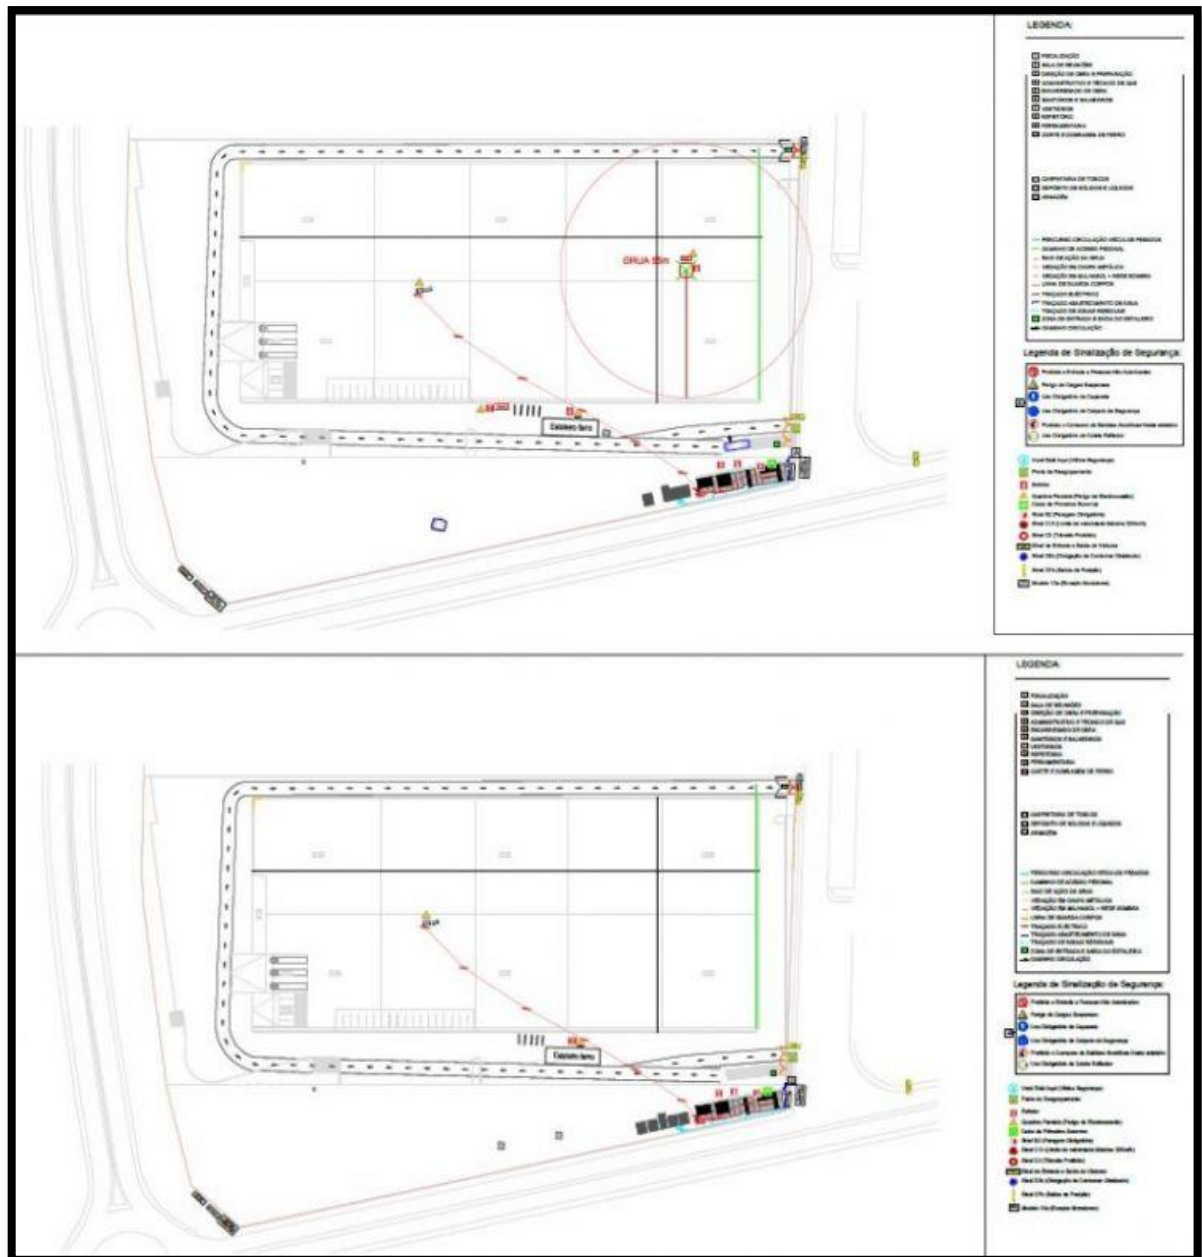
Evolução da planta de estaleiro apresentada ao longo do estágio
